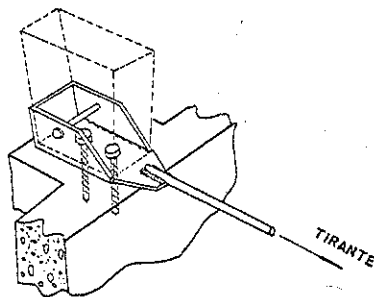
Tirante de Aço Soldado na Placa de Apoio
